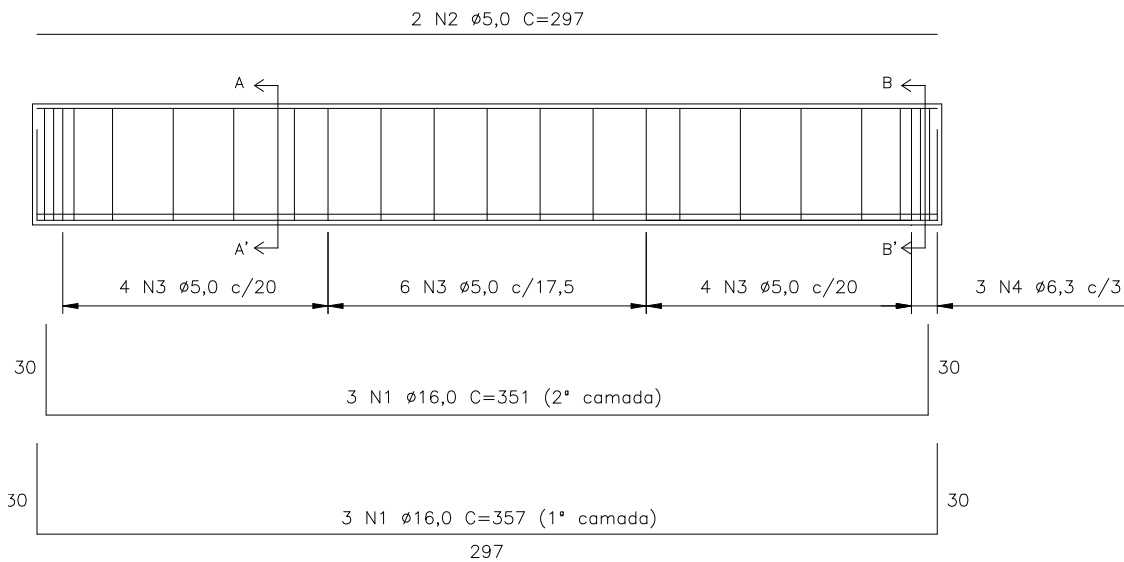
Armadura longitudinal das vigas da Série II.
